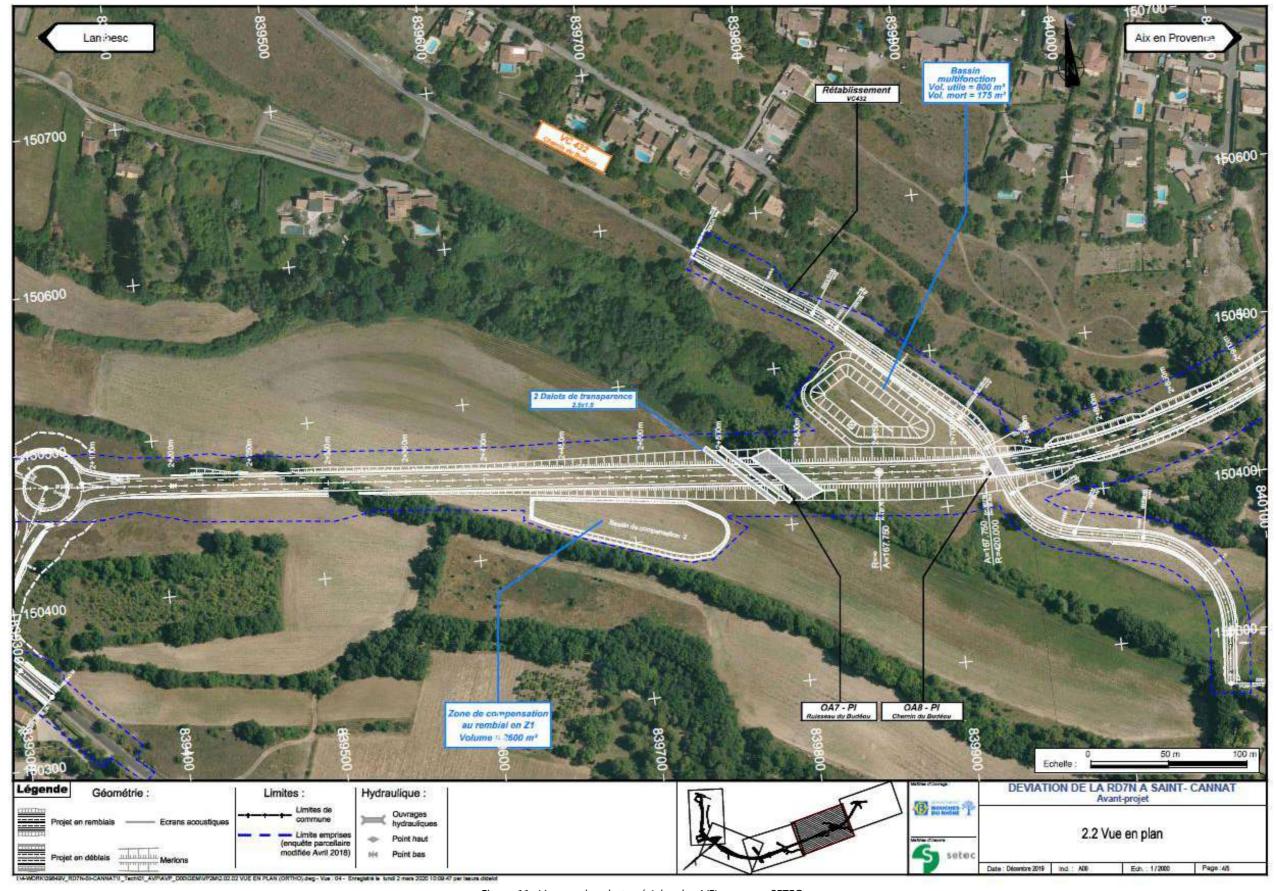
Vue en plan du tracé (planche 4/5) ; source : SETEC
